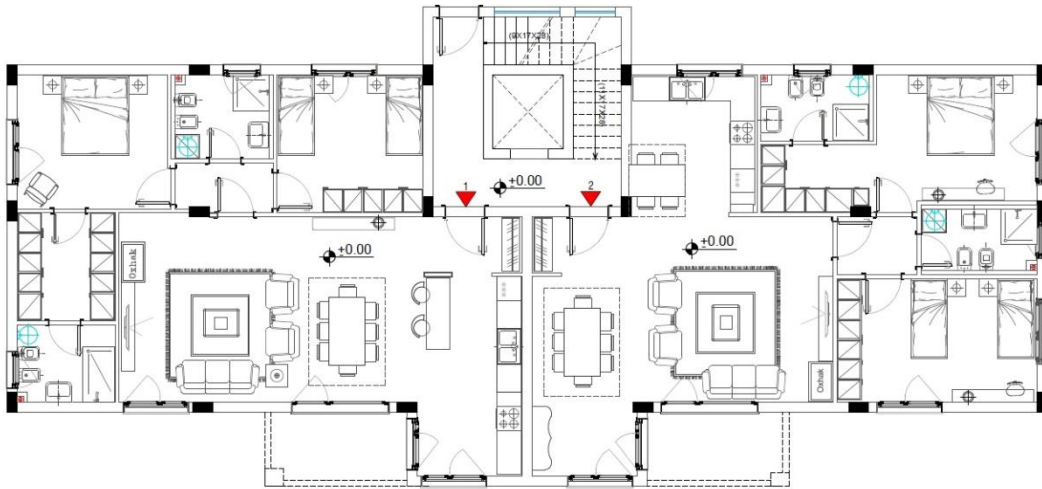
Banesa shumëfamiljare (A), plani i katit përdhe.
